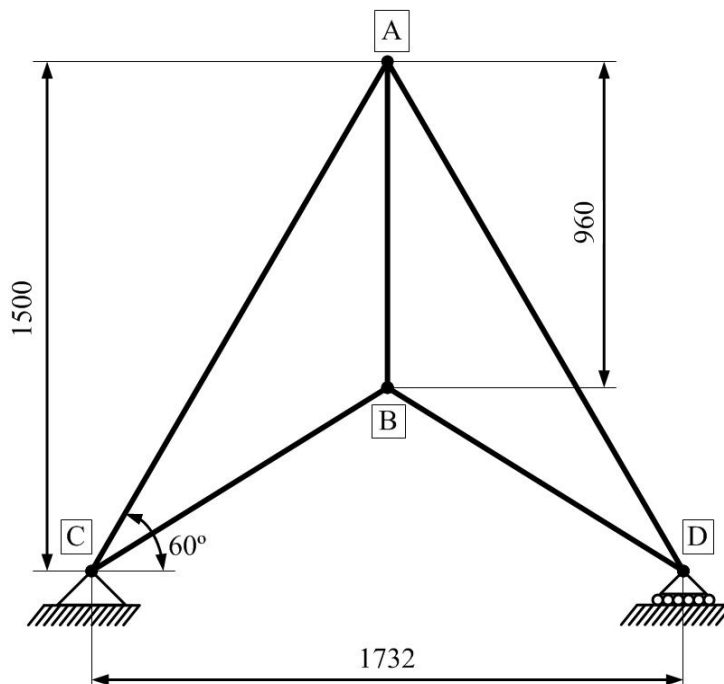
Estrutura de suporte inferior da turbina (estrutura treliçada)
